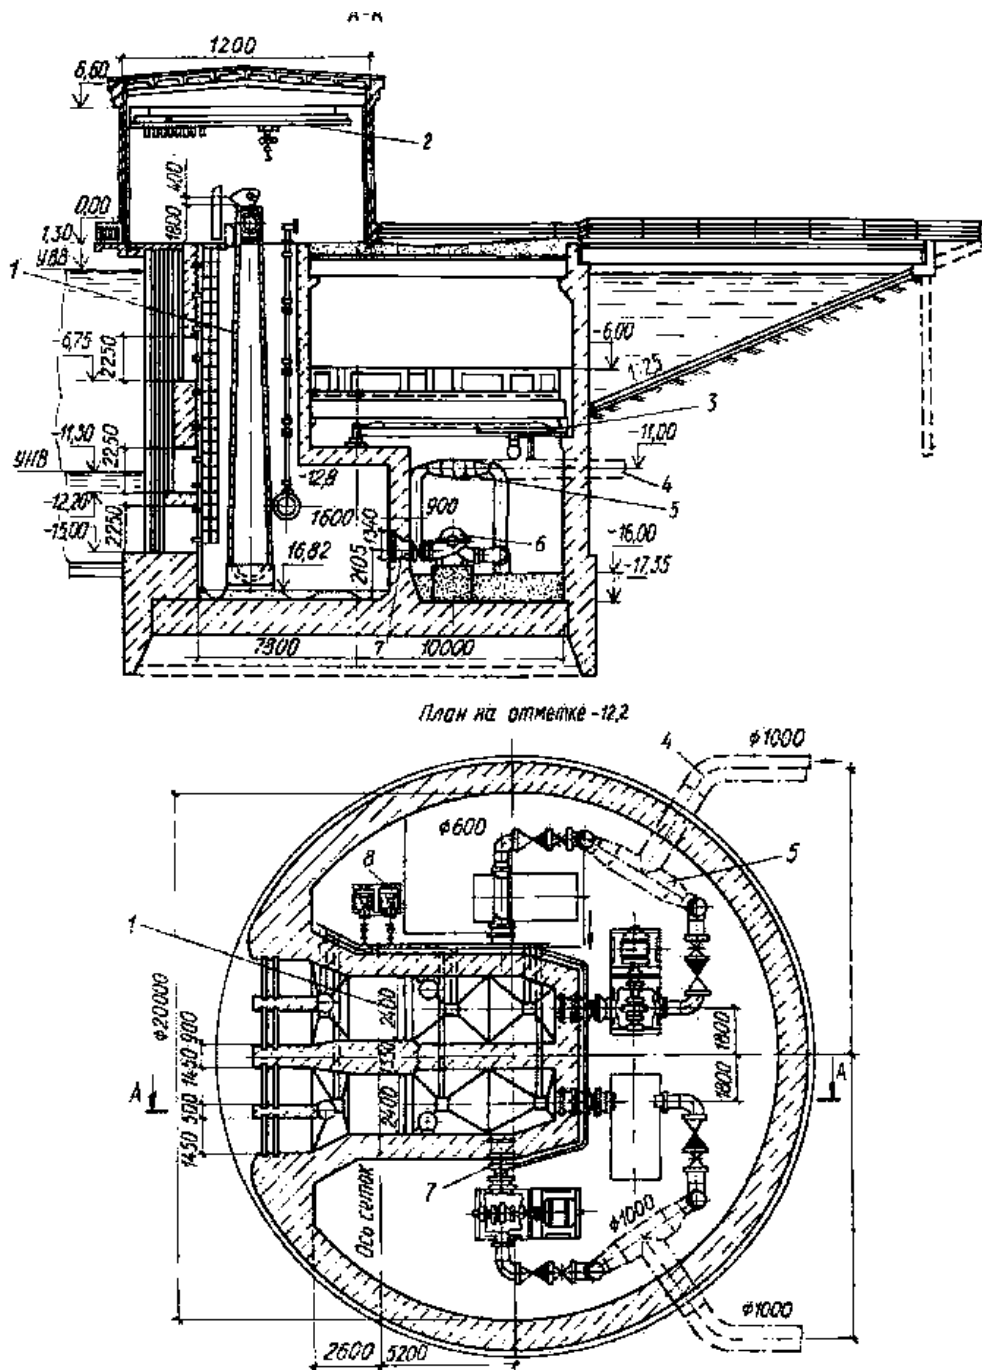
Берегова насосна станція першого підйому із внутрішнім водоприймачем: 1 - обертальна сітка; 2 - кран-балка (5 т); 3 - радіальна кран-балка (10 т); 4 - нагнітальний трубопровід; 5 - нагнітальний колектор; 6 - насос; 7 - усмоктувальна труба; 8 - дренажна установка
